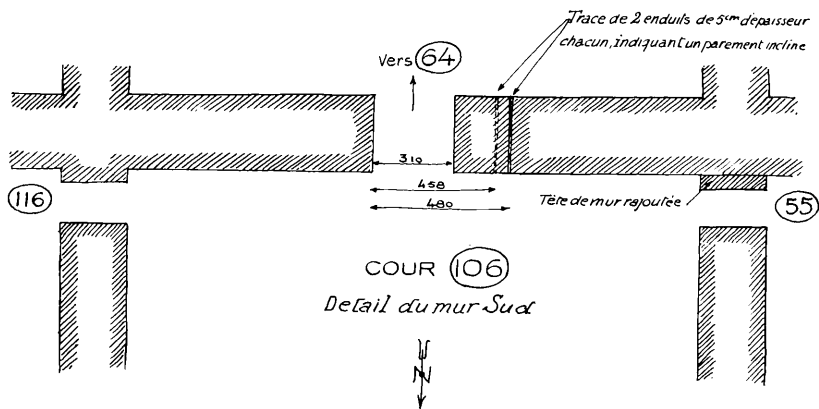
Cour 106. Mur sud. Modifications structurales de la porte 106-64.
